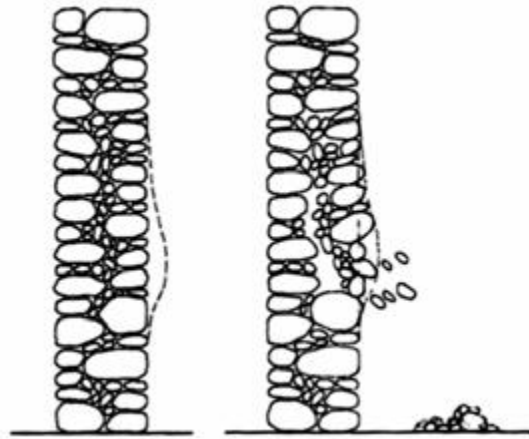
Colapso do pano exterior devido a fraca ligação transversal (Binda L., 2006)
